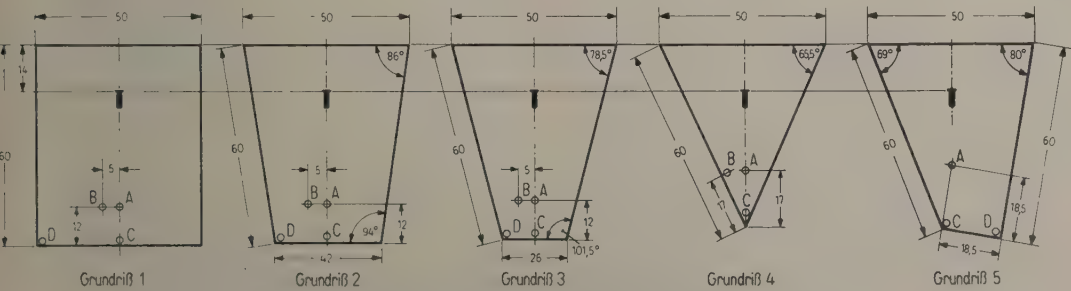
Modellraumgrundriß und Lichtquellenorte.
